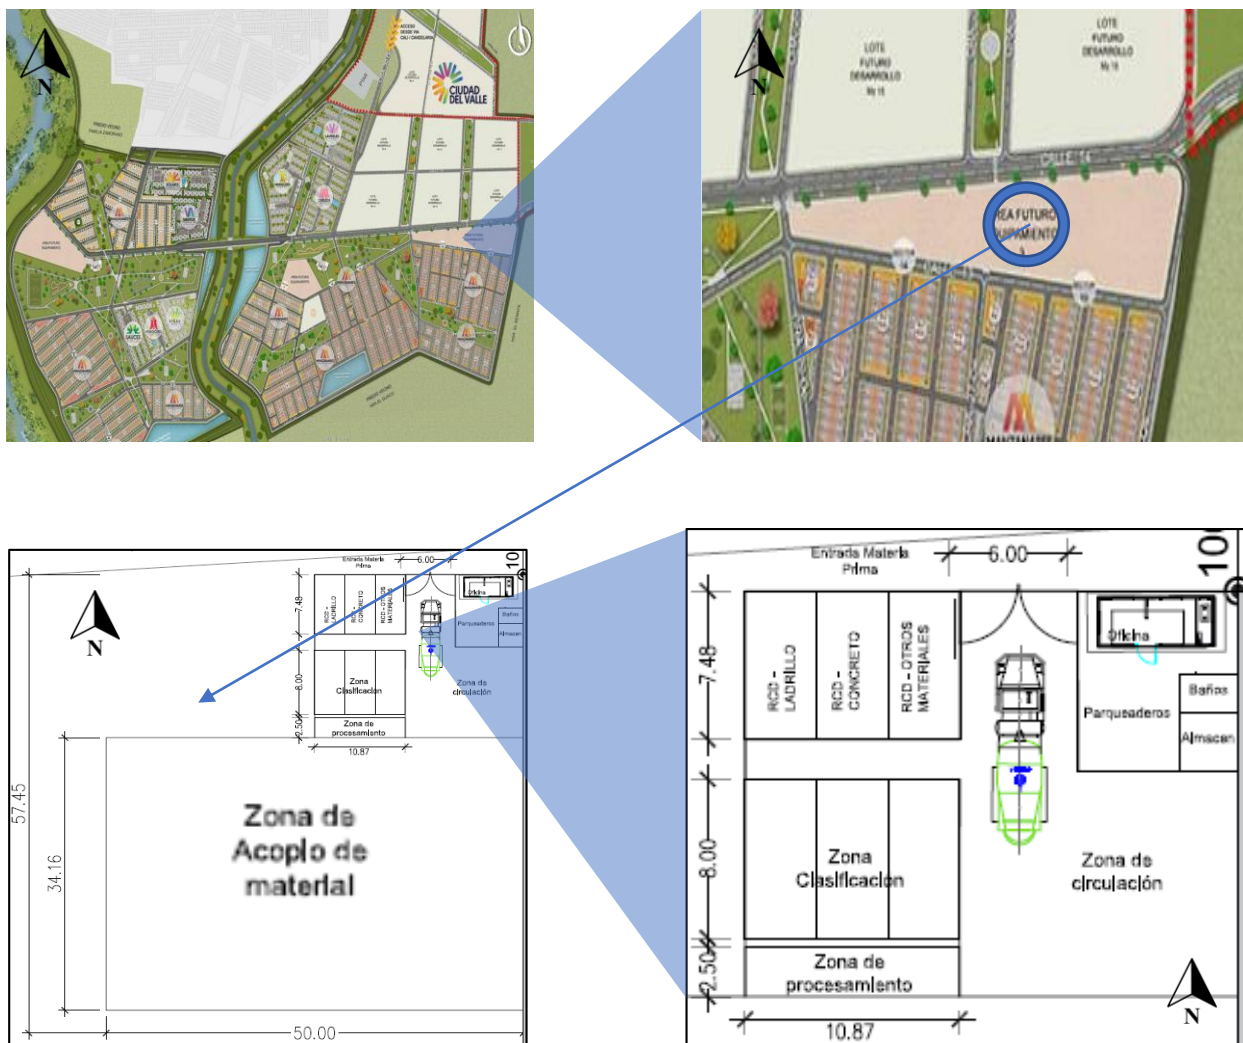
Ubicación planta producción RCD en planta macro proyecto Ciudad del Valle (Constructora Bolívar, 2019).
